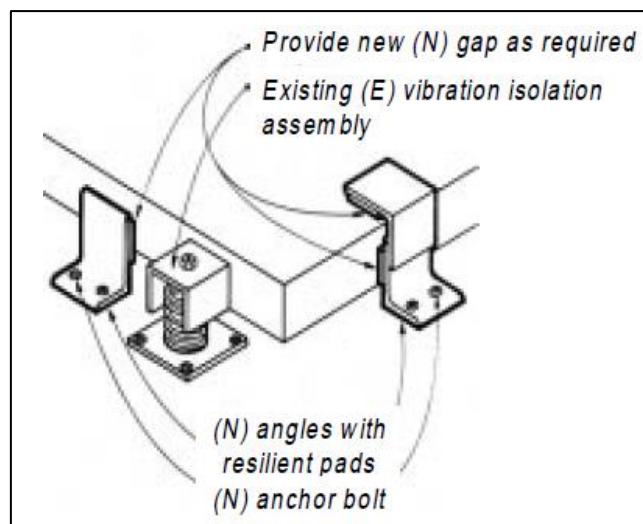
Se muestra el anclaje de la base de un equipamiento a un soporte estructural a través de perfiles metálicos con juntas de goma, con un aislador de vibración previamente existente.
